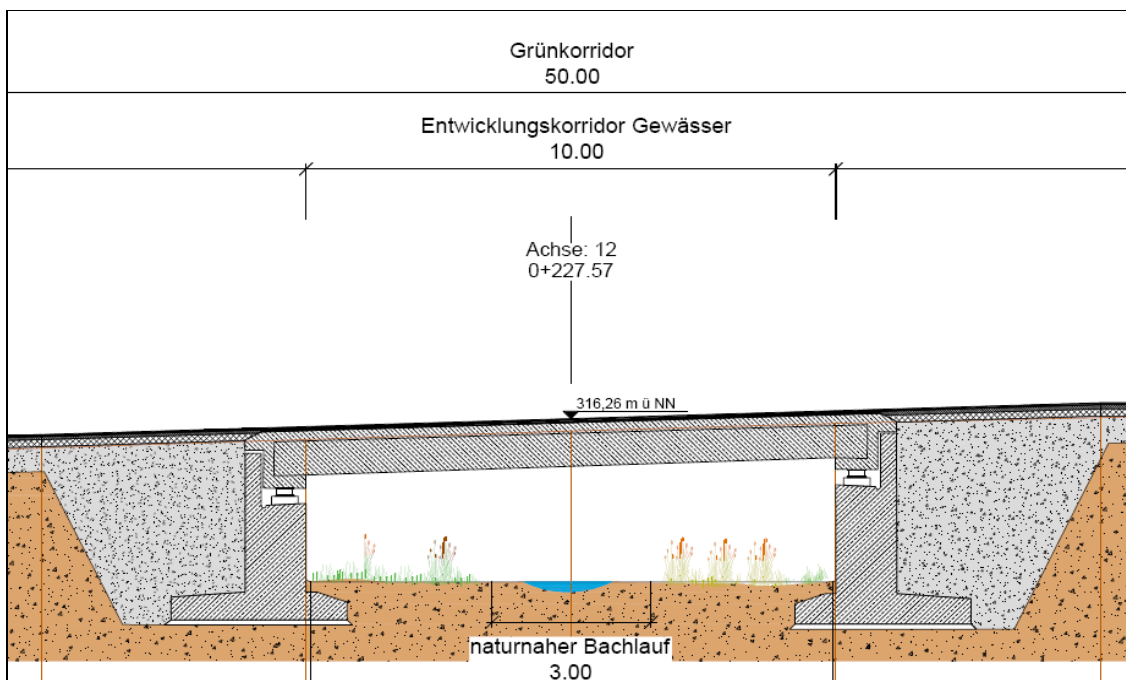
Geplantes Brückenbauwerk im Bereich des Grünkorridors (Quelle: Antrag auf Gewässerverlegung Industriegebiet „Am Dachsberg“, Planungsbüro Dittrich)
